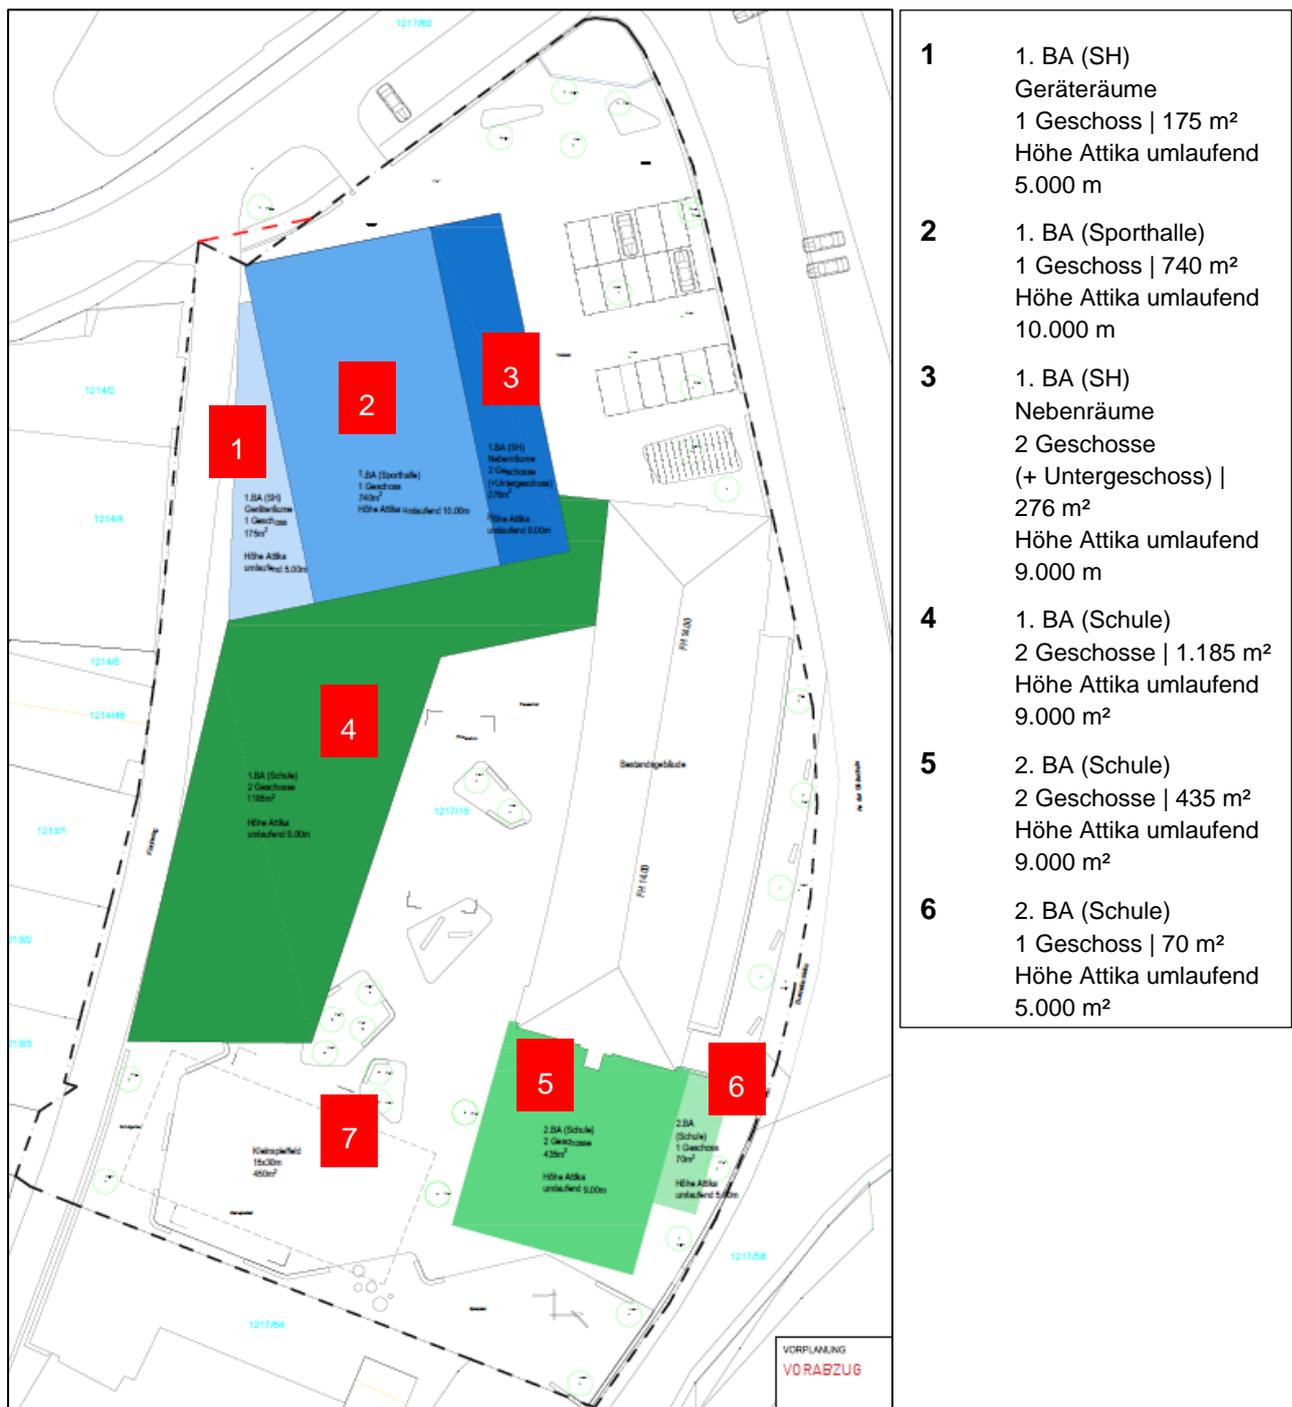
Vorplanung Erweiterung Grundschule und Neubau Sporthalle
